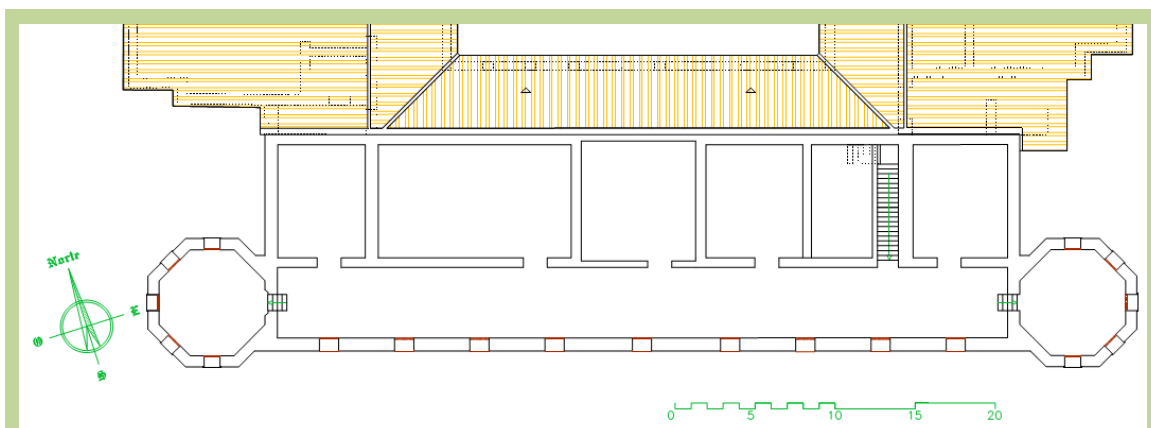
Planta primera del ala sur de La Olmeda (reconstrucción virtual -II-). CGS.
